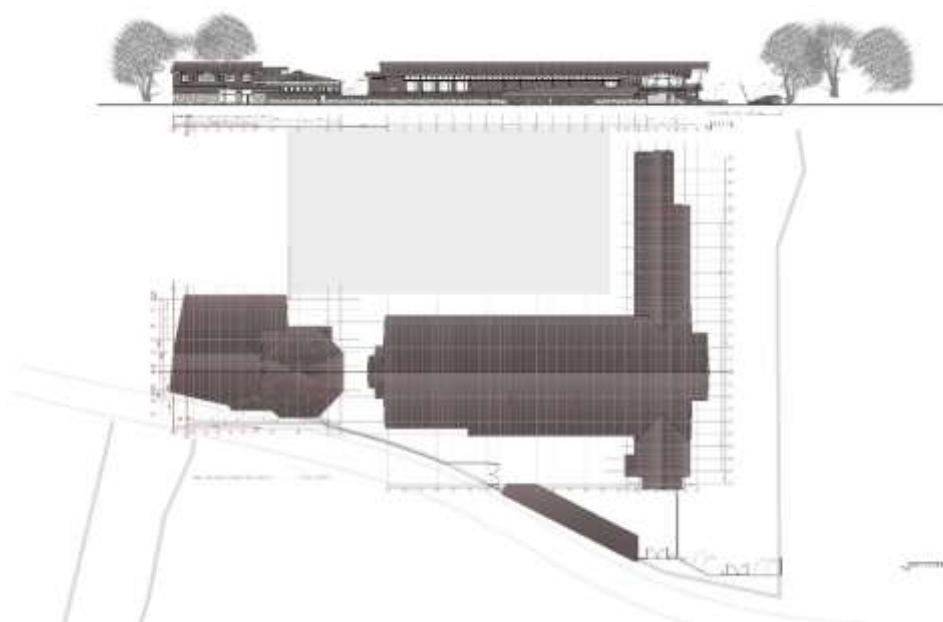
Креслення фасаду та схеми даху. [2]
